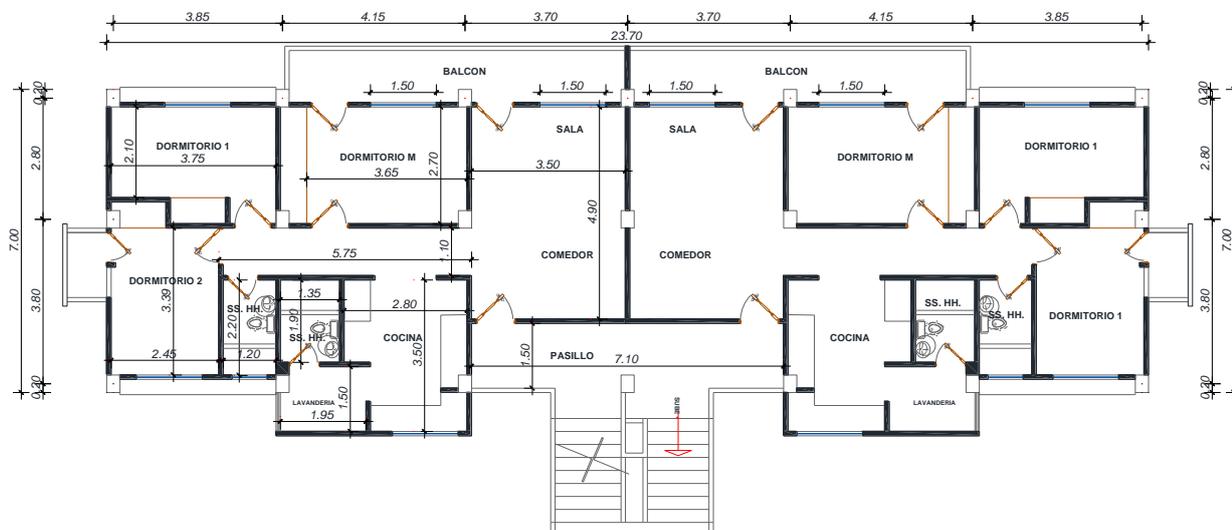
Planta arquitectónica acotada, modelo tipo lineal.
